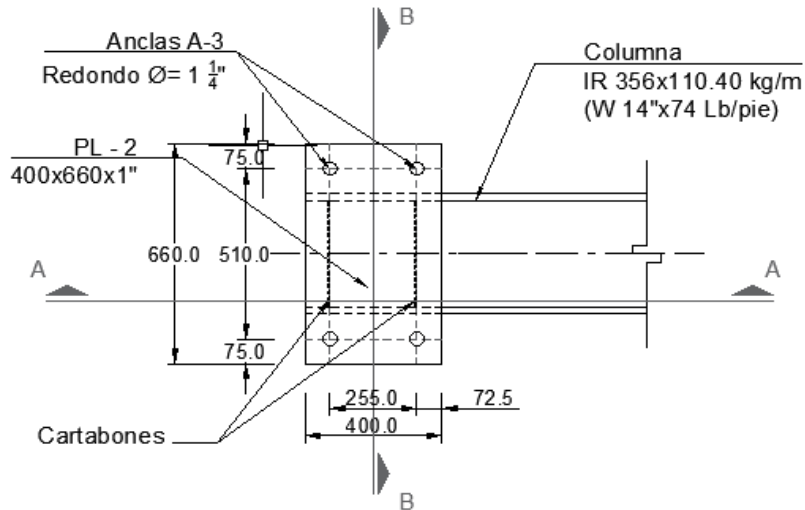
Detalle de los apoyos, vista en planta. Cotas en milímetros
